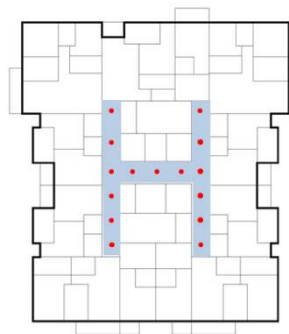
Penerapan bangunan yang panjang dan tipis
